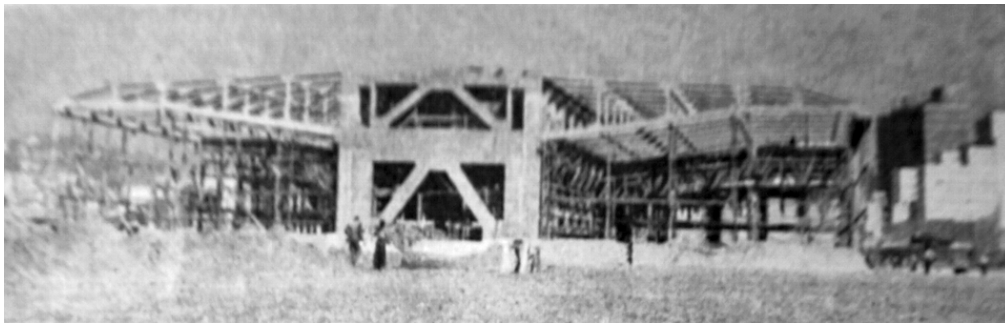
Hangar N.1, foto da construção. Corpo central com 15 m de largura e treliças em balanço com 23,30 m para cada lado. FONTE: CONCRETO, 1945.
